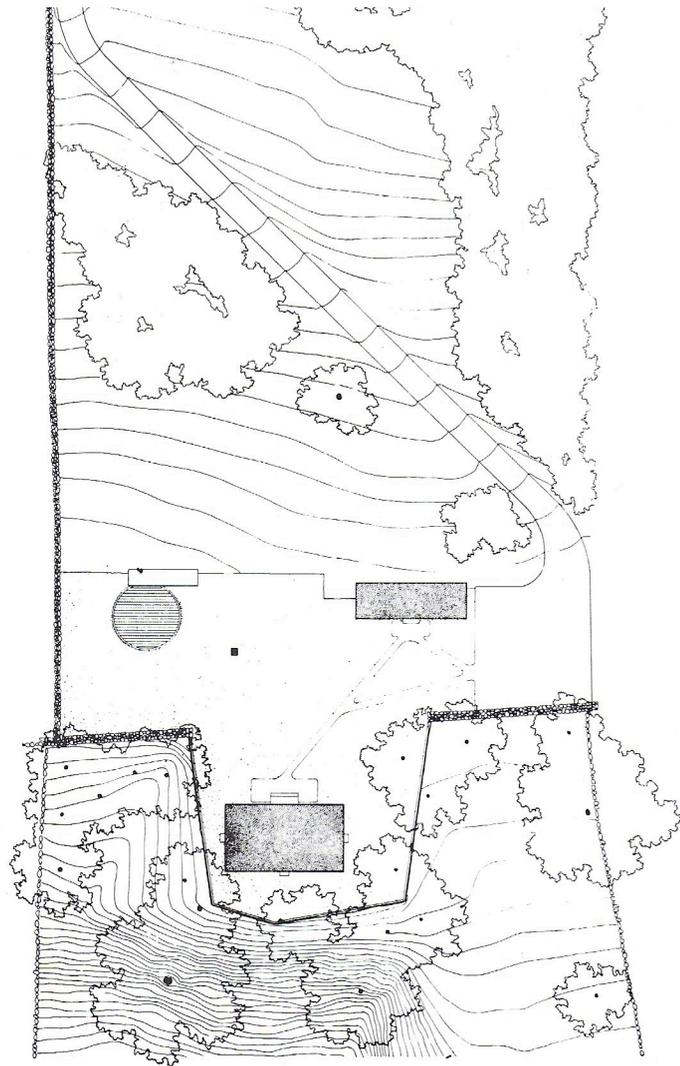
Philip Johnson, Glas House, 1945–1949, Site plan in Banham 1984, 233.
